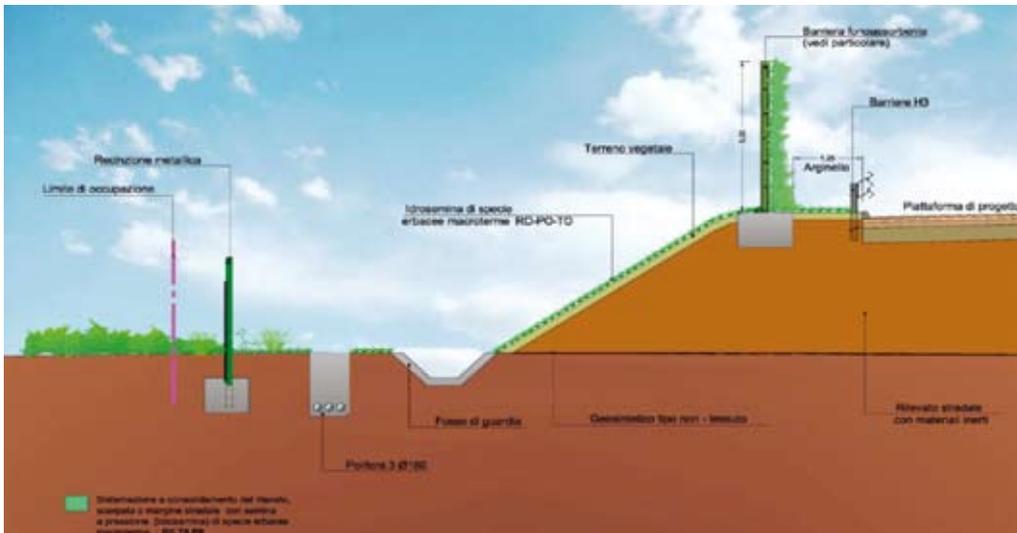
Esempio rilevato con opere a verde e barriera fonoassorbente
